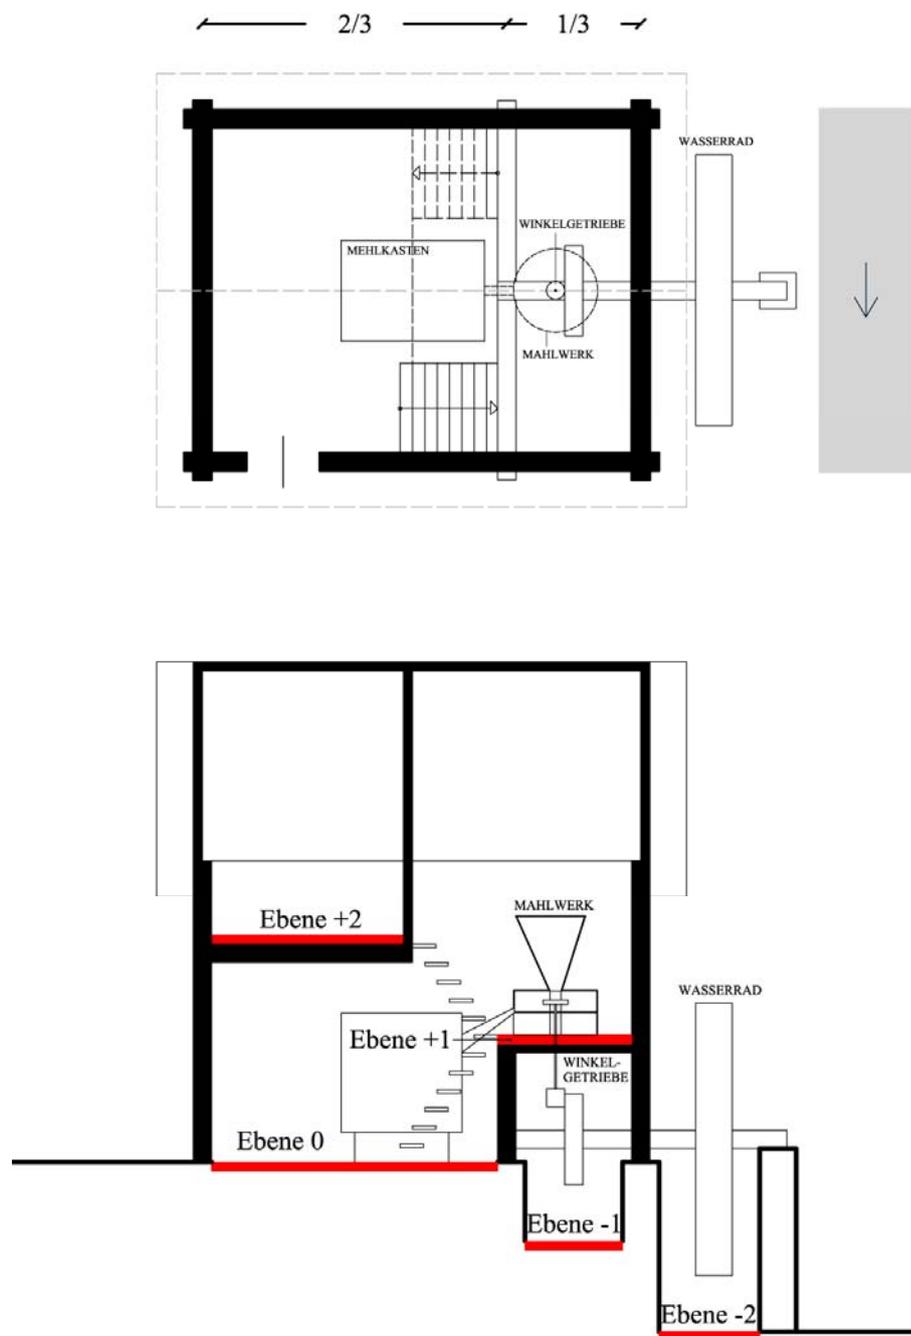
Schematisches Beispiel der Grundriss- und Ebenenaufteilung einer einläufigen Hausmühle
